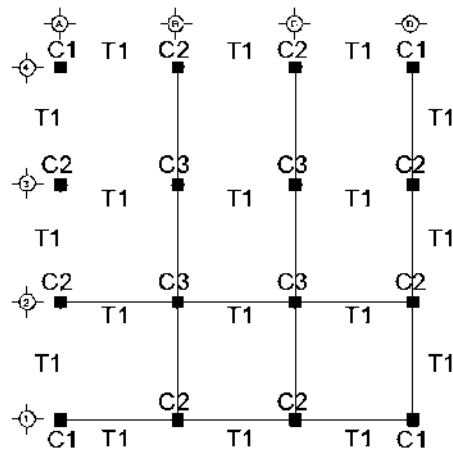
Clasificación adquirida de columnas (C) y vigas (T)
